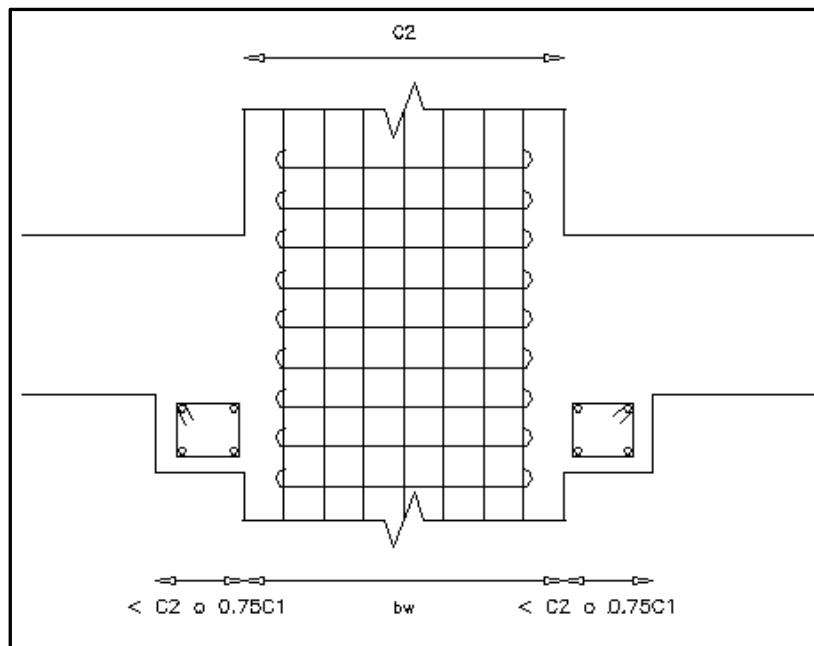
ANCHO DE VIGA ESTABLECIDO POR LA ACI
